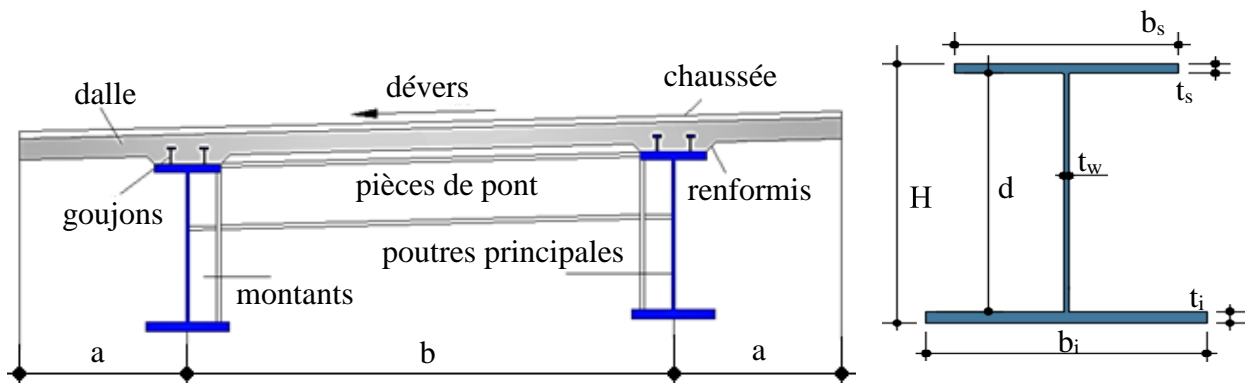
Profil en travers d'un bipoutre à Pièces de pont
